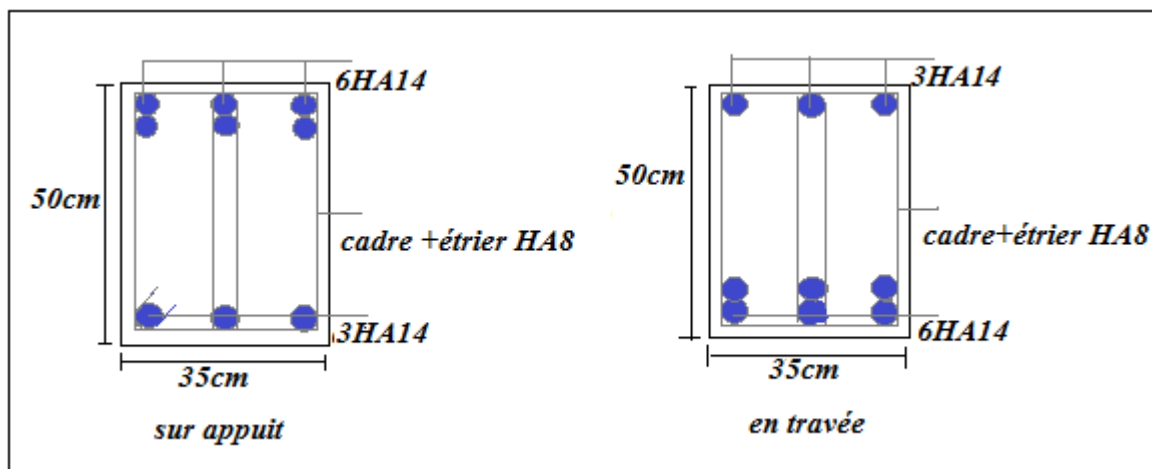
Ferrailage de poutre secondaire pour terrasse et étage
